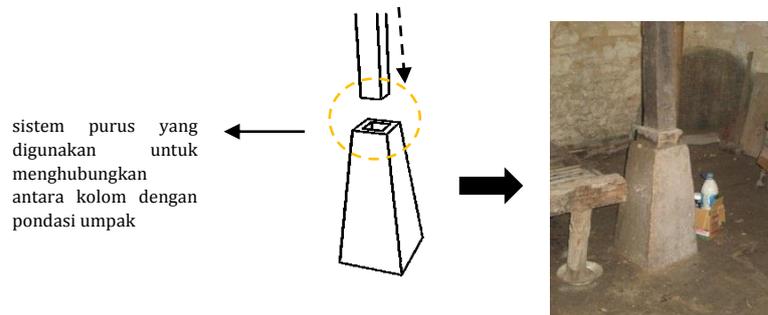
konstruksi pondasi pada rumah *pandhapa
